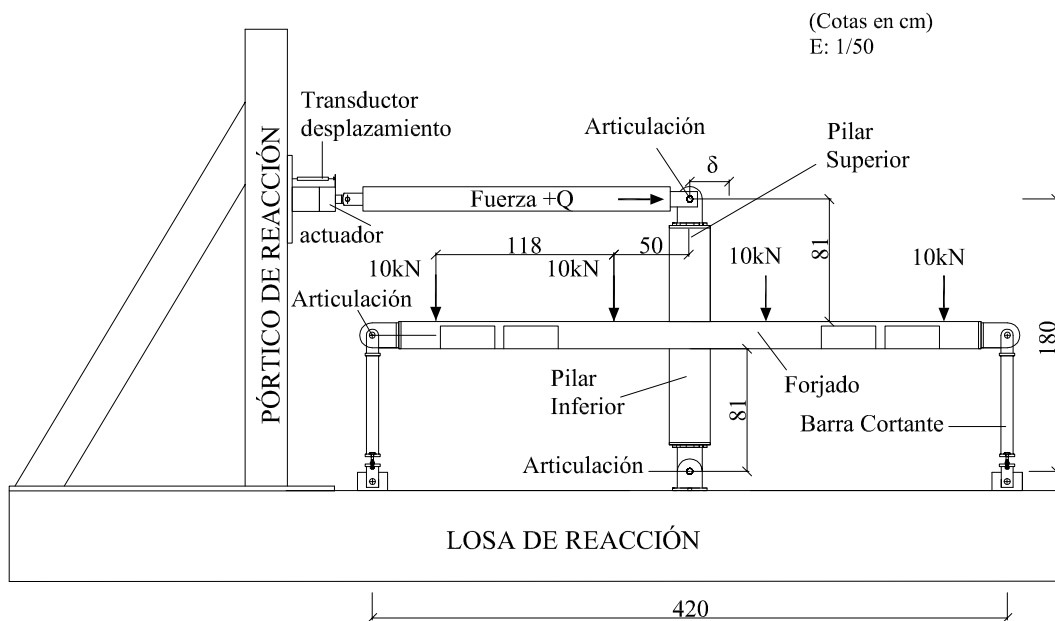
Detalles del montaje del espécimen de conexión pilar-placa interior
